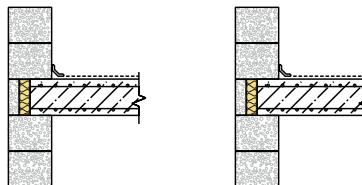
Варианты пере́крытий по стенам из блоков AEROC
